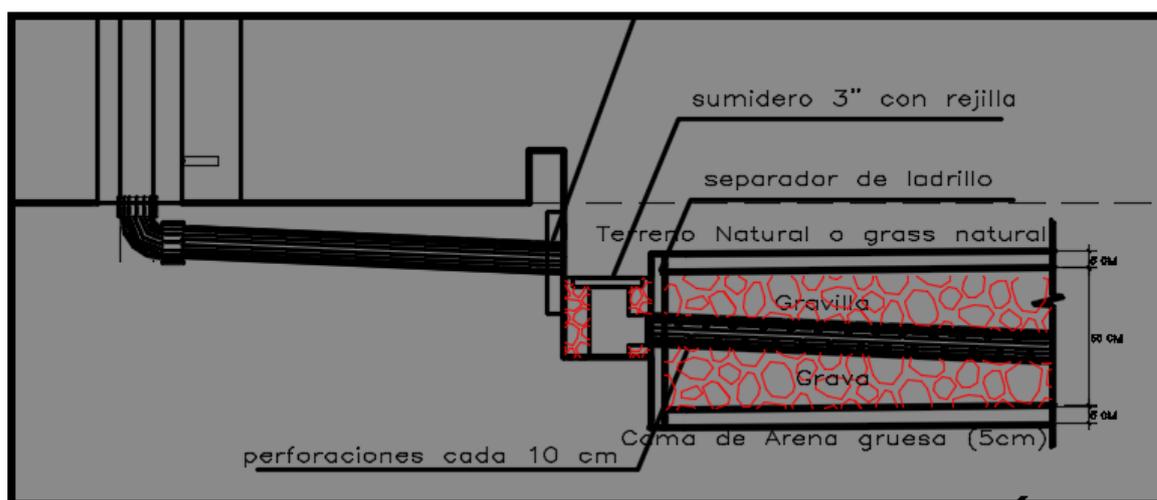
Detalle del Drenaje francés a instalar en el proyecto
